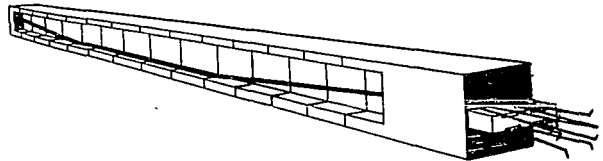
Viga Prefabricada de Dovelas, con cables y anclaje expuesto.
